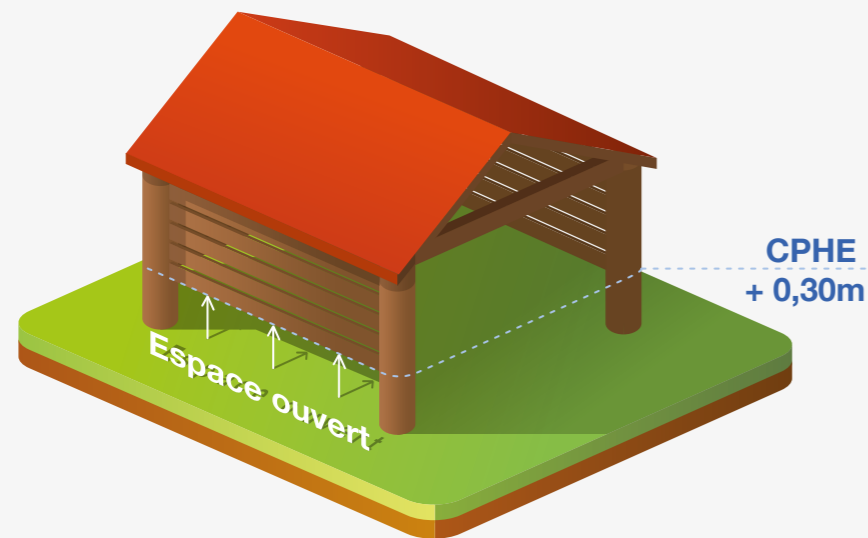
Illustration d'une construction autre qu'un bâtiment ne comportant pas de paroi sous la CPHE.
